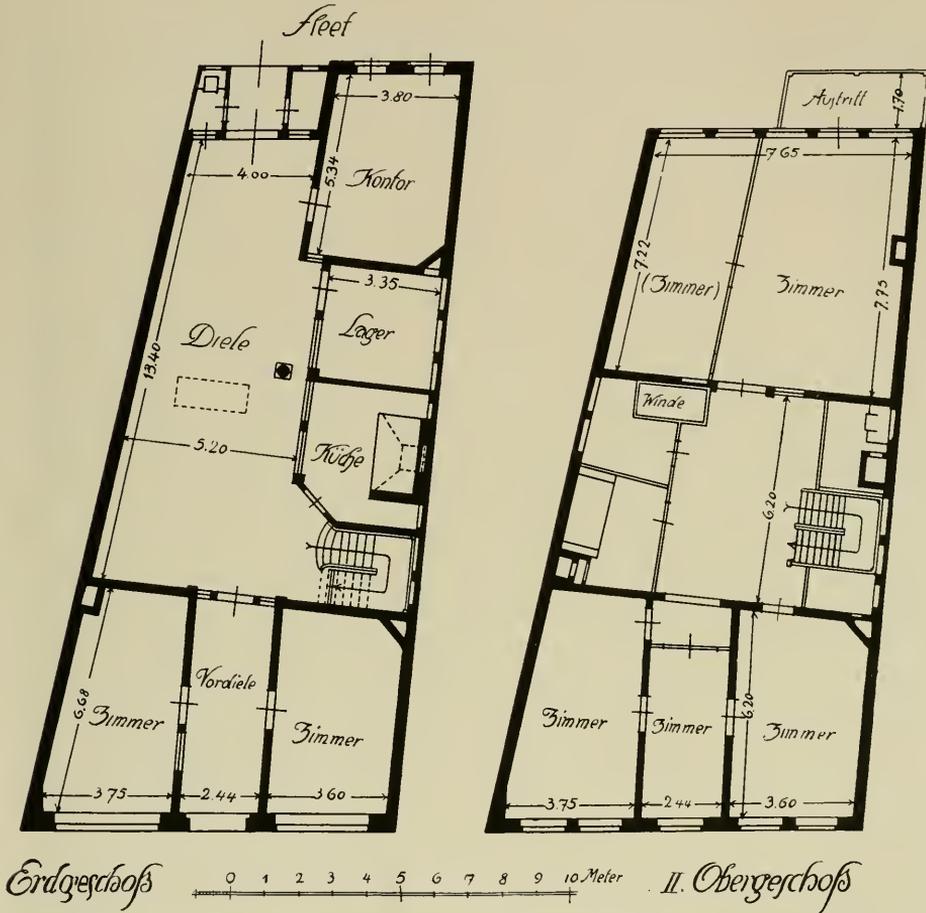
Grundrisse des Erdgeschosses und des II. Obergeschosses des Hauses Deichstraße Nr. 53.
